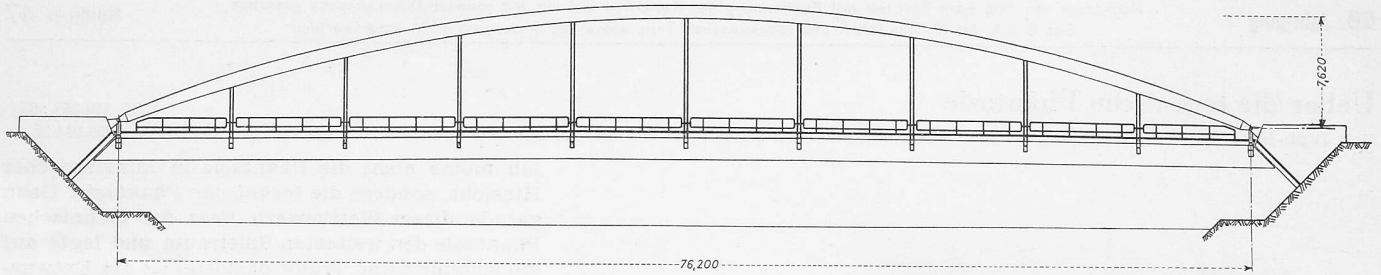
Brücken-Aufriss 1:500 zum Wettbewerbsentwurf
